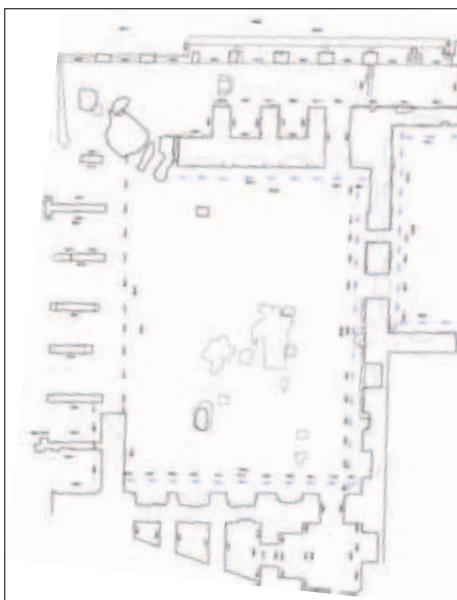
/81 Grundriss der Bauaufnahme 2003.
